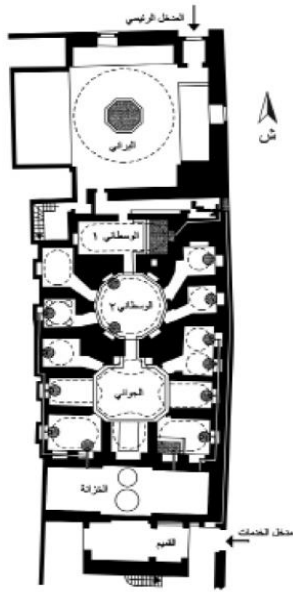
مسقط أفقي لحمام العصبياي بمدينة حمص
